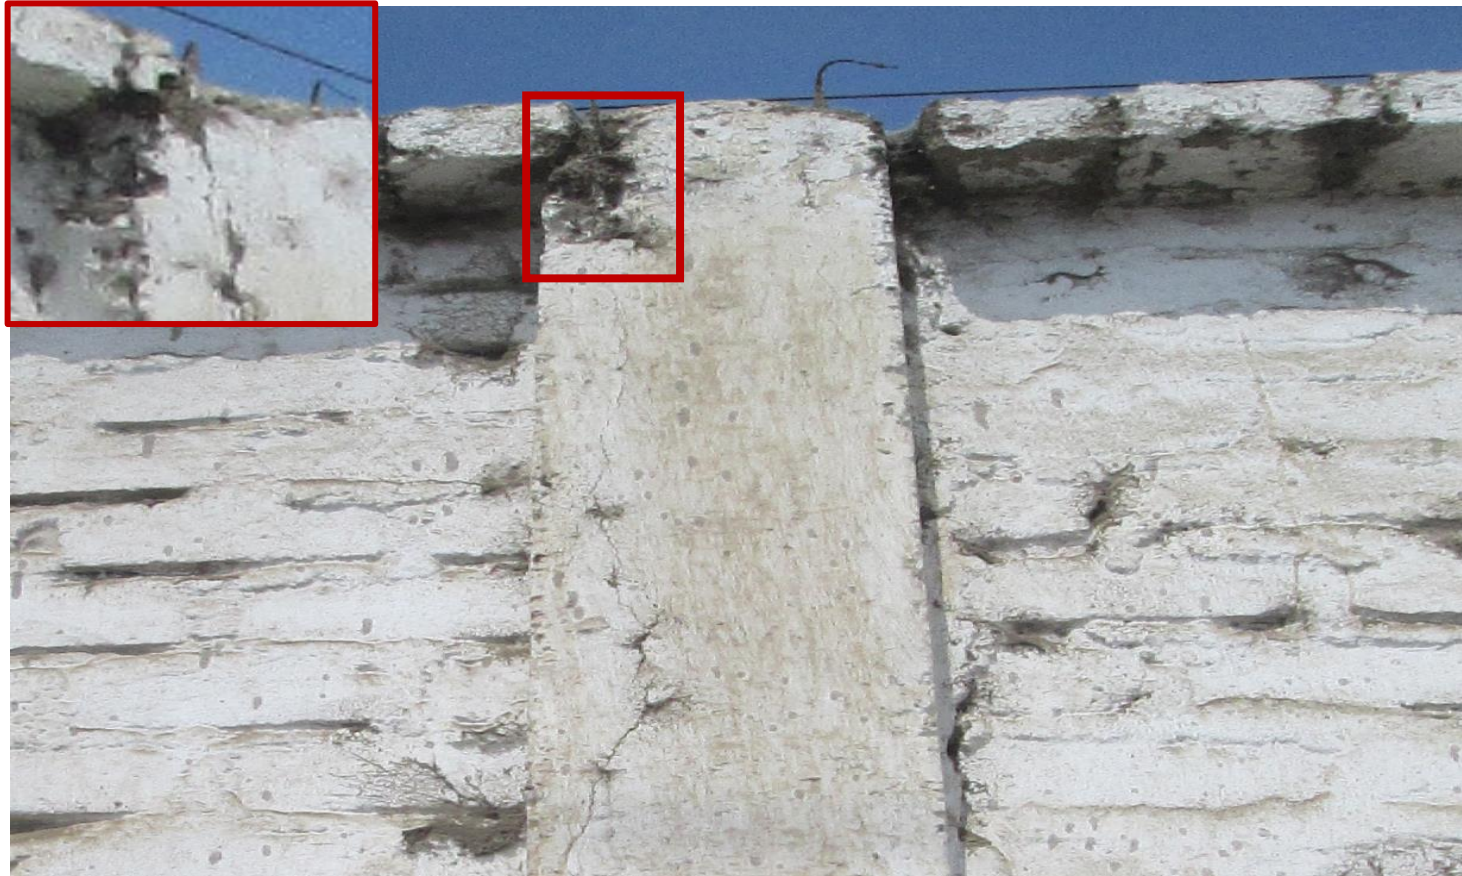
Columna afectada por grieta en la unidad muestral 09.
